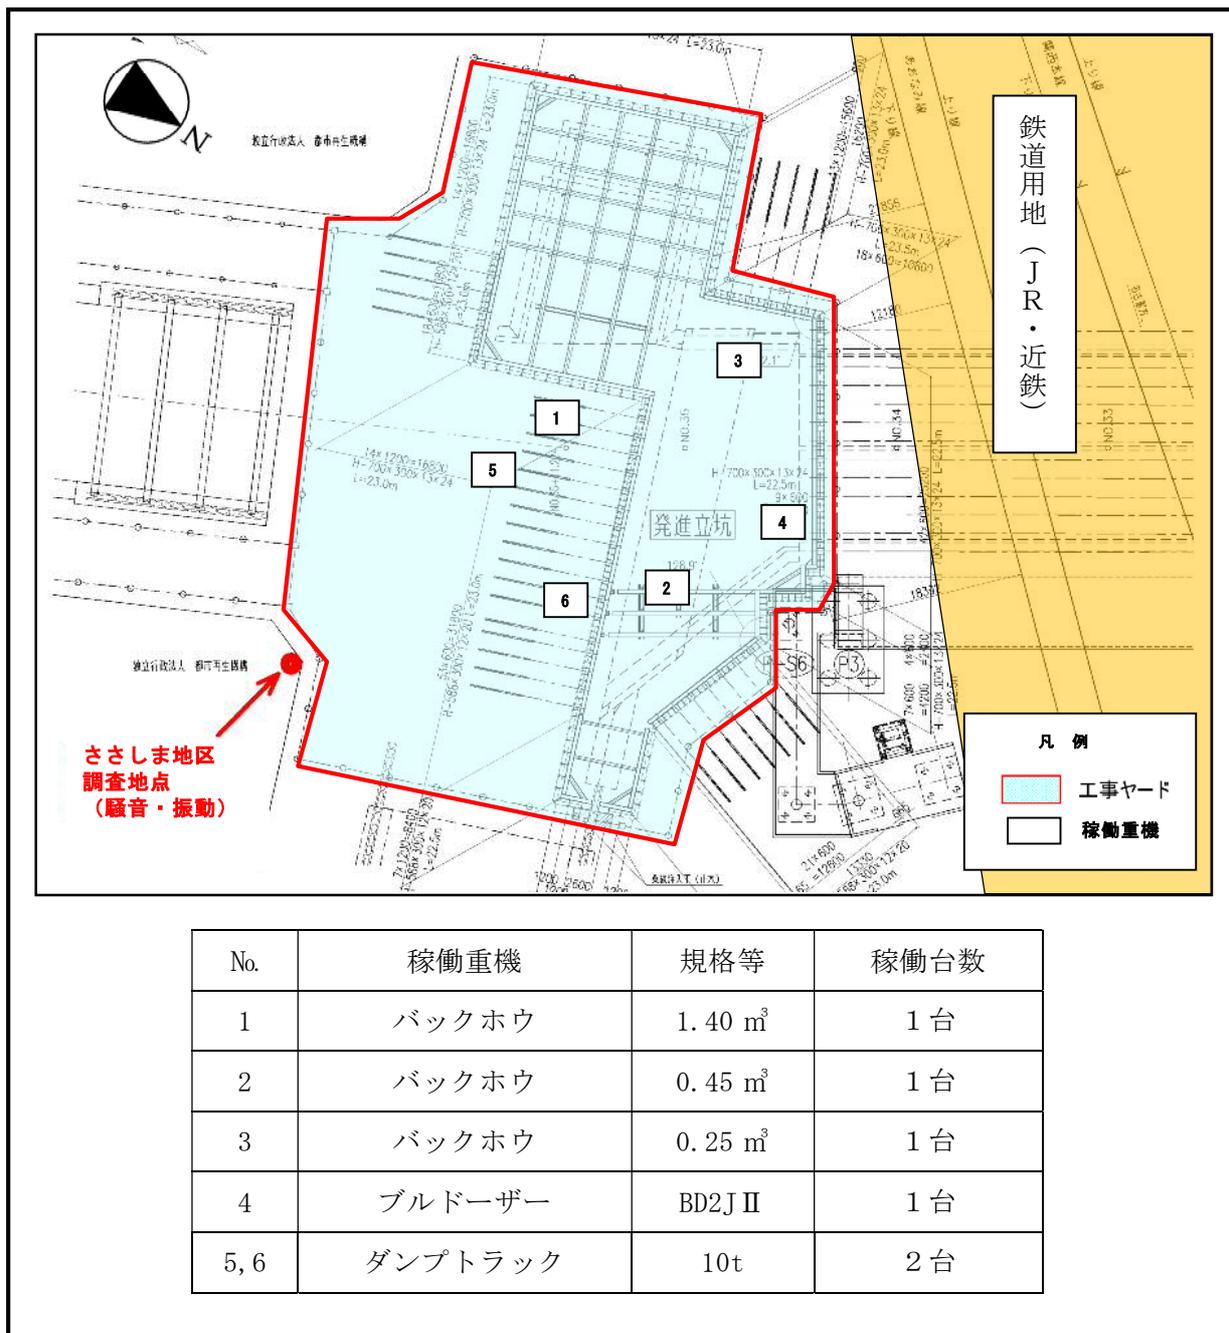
(2) 建設機械配置図 (函体工事 (土工) : ささしま地区)
